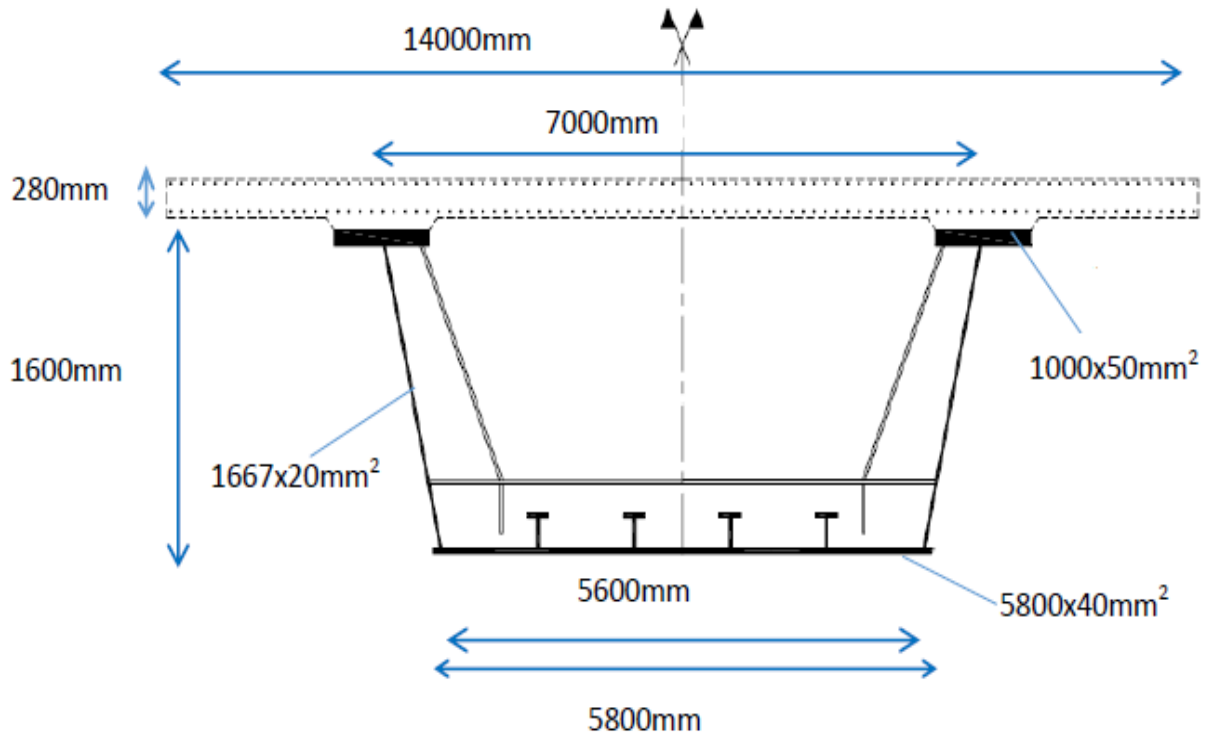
Paramètres du dimensionnement du caisson ouvert
